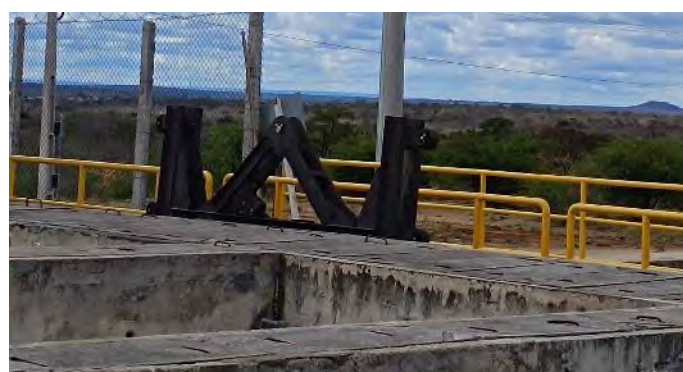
Barragem Serra do Livramento - Viga Pescadora
